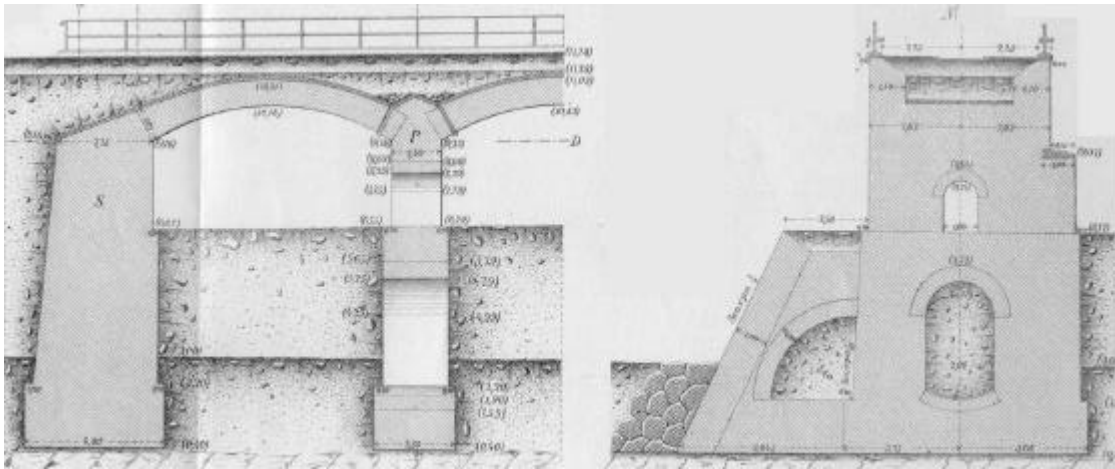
Sezione longitudinale e trasversale di fondazione diretta (Curioni, 1871).
